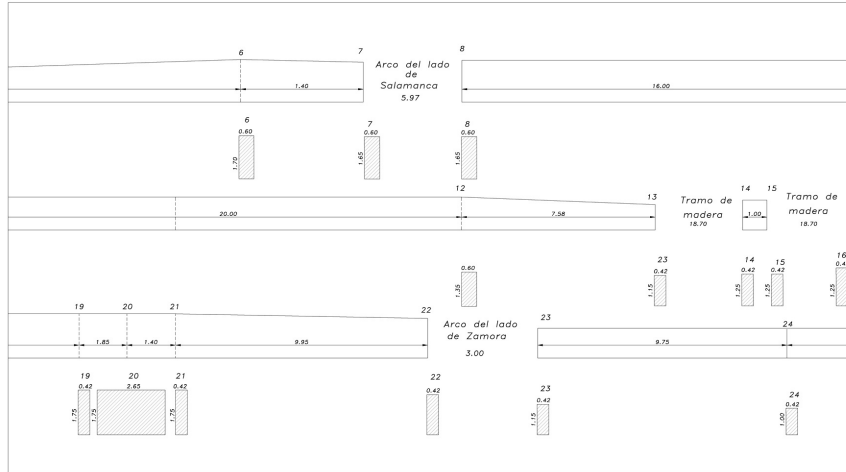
Detalle del levantamiento de Pretiles del puente de piedra. Plano perteneciente al proyecto de la Parte 1ª, “Demolición de pretiles y torreones”.
